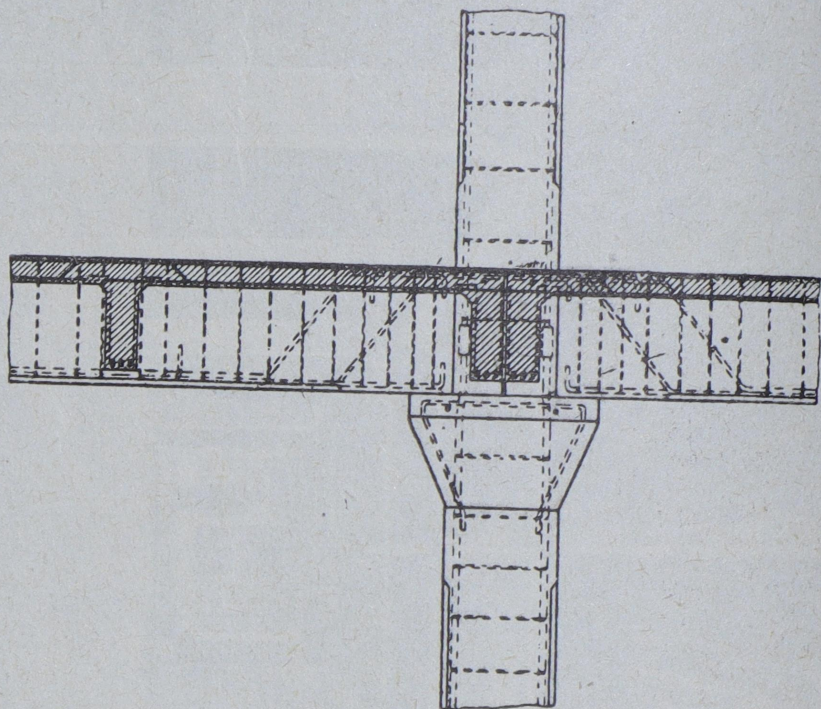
Арсеналъ ландвера въ Вѣнѣ. Соединеніе главной балки со столбомъ.
